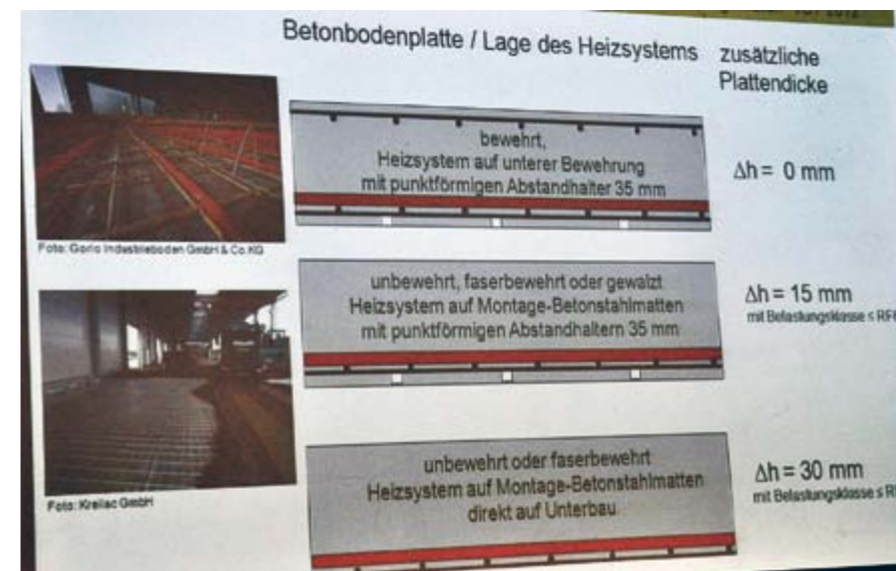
Empfohlene Zuschläge zur Betondicke bei Fußbodenheizungen
